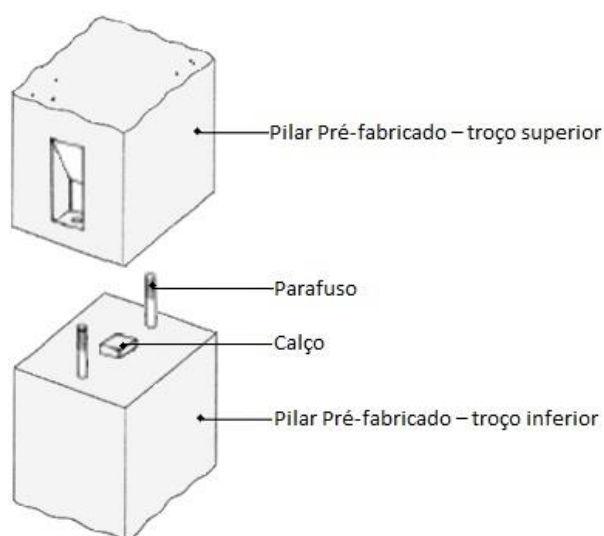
Ligação Pilar – Pilar por parafusos [46]
